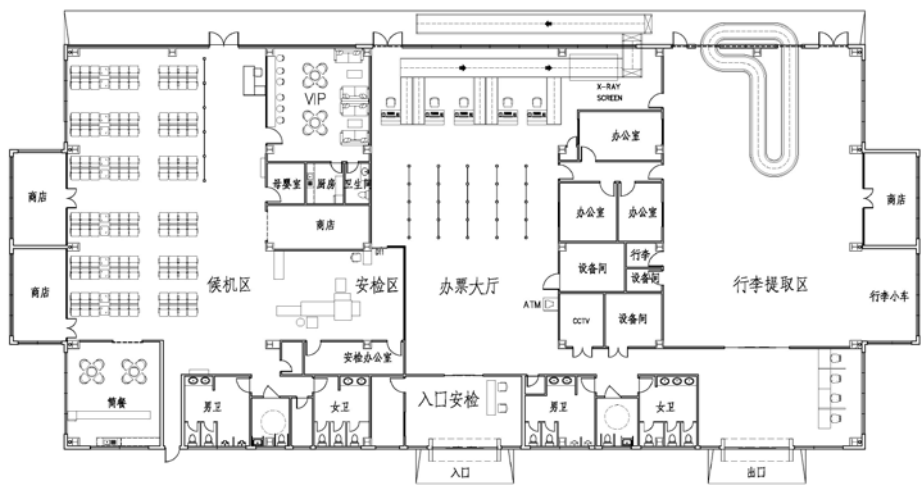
巴布亚新几内亚马努斯省莫莫特机场平面图
